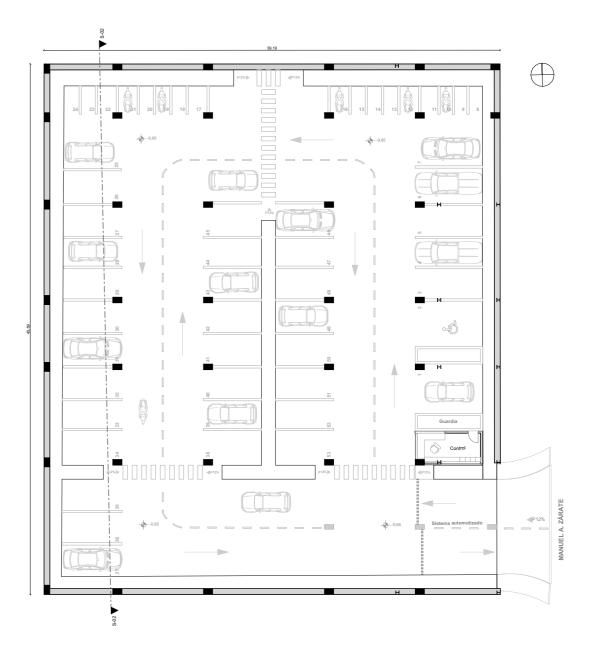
Bloque 4 - planta de estacionamiento ESC_1:325 Elaborado por: Autor
